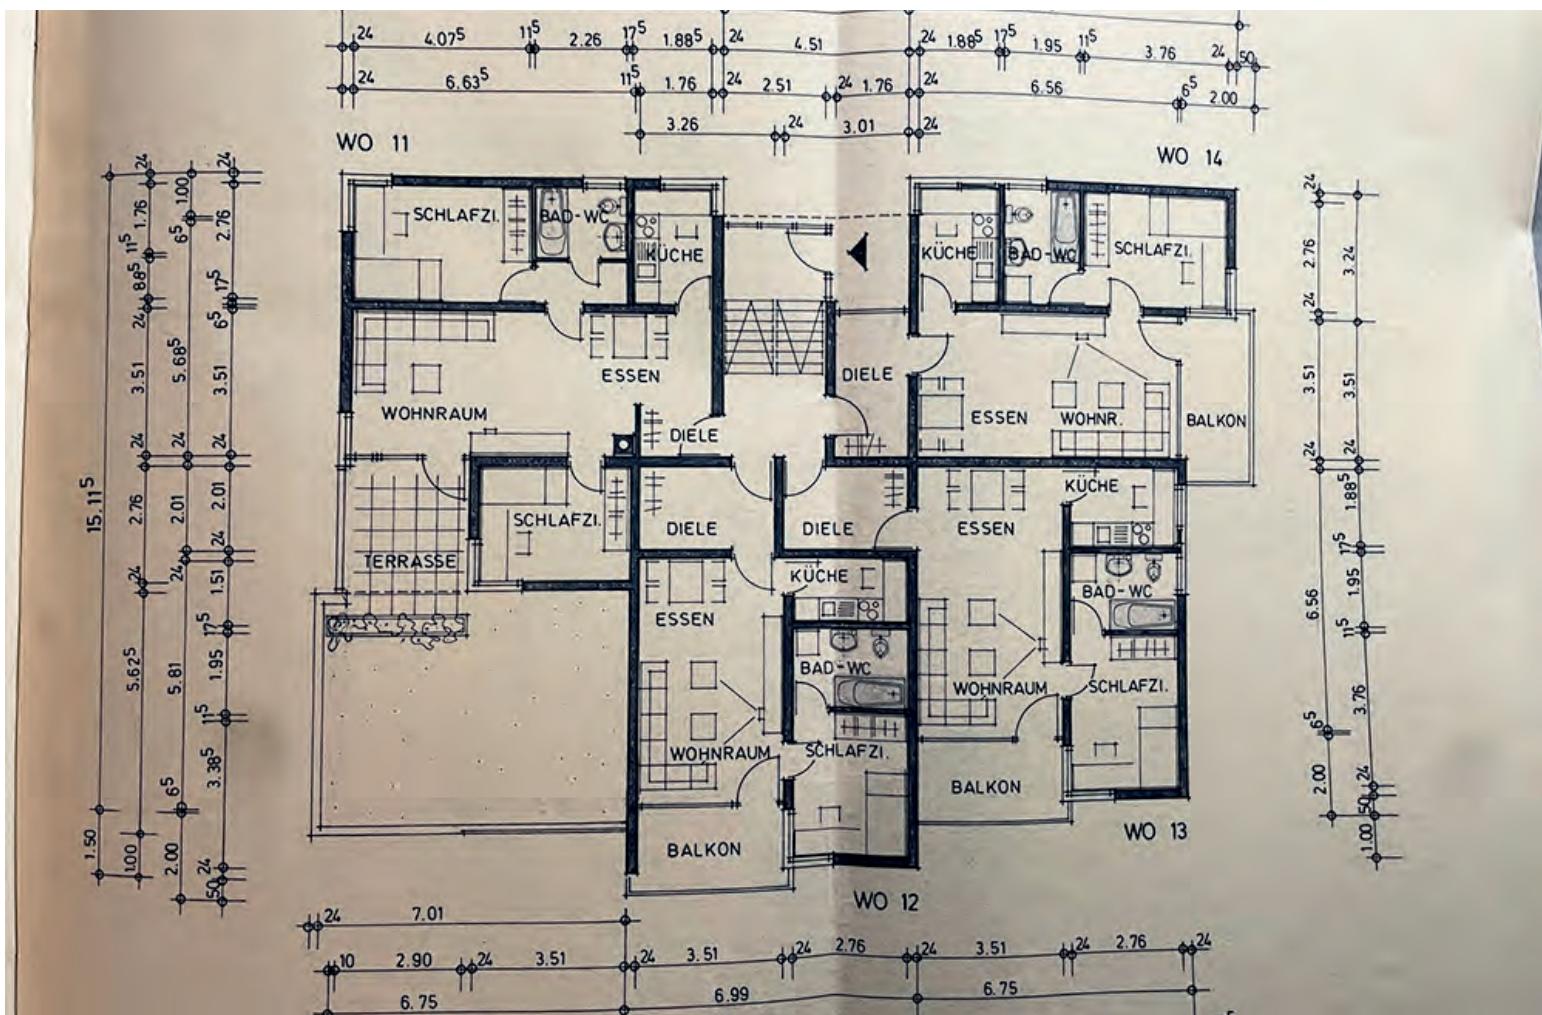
Zimmer-Wohnung mit 52 m² in Herrenberg
